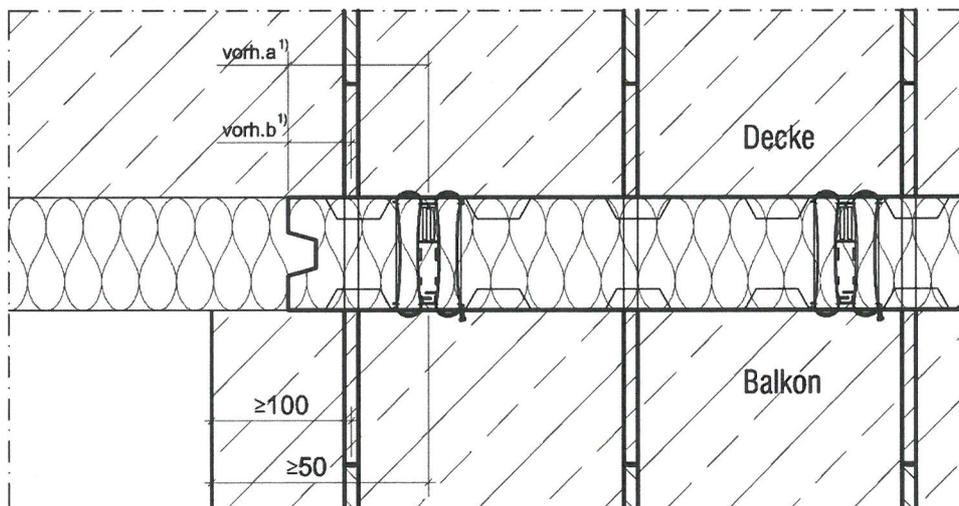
Detail A: Rand- und Dehnfugenabstände der Querkraftstäbe und Betondrucklager (Maße in mm)
